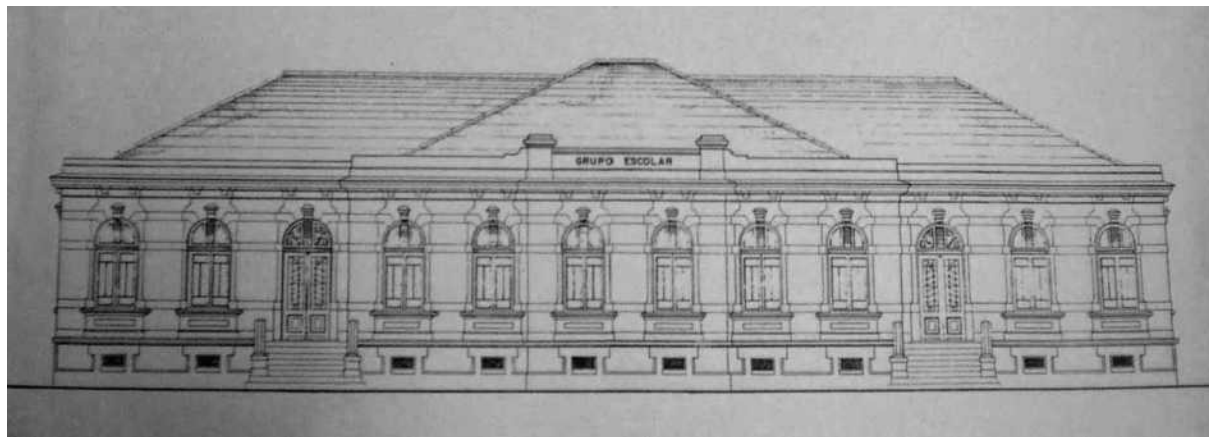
Fachada antes da intervenção. Fonte: arquivo do FDE.
